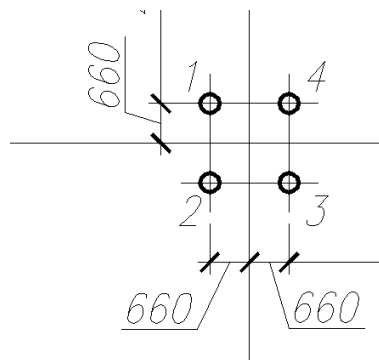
Фрагмент расположения свай под колонну каркаса
